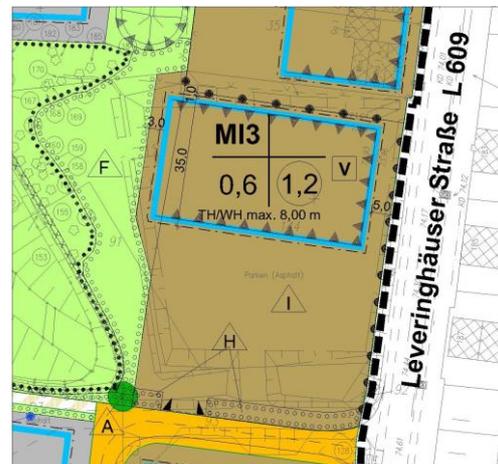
Gegenüberstellung des Änderungsbereiches im Bereich der MI 3- Flächen im Bebauungsplan Nr. 52 „Service- und Gewerbestraße Leveringhäuser Feld“
